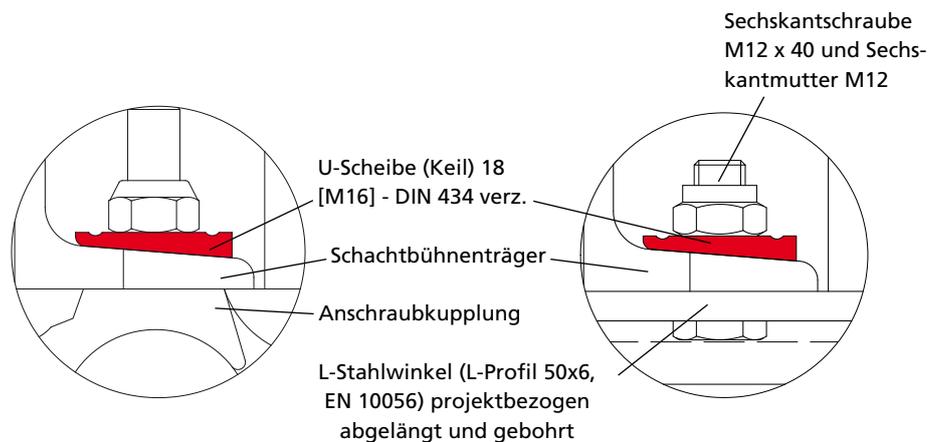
Detail / Befestigung der Anschraubkupplung
